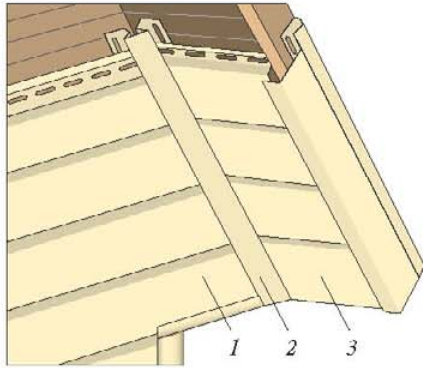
Монтаж внутреннего углового профиля на щипец: 1 — обшивка щипца рядовым сайдингом; 2 — внутренний угловой профиль Döcke; 3 — обшивка свеса крыши софитами
